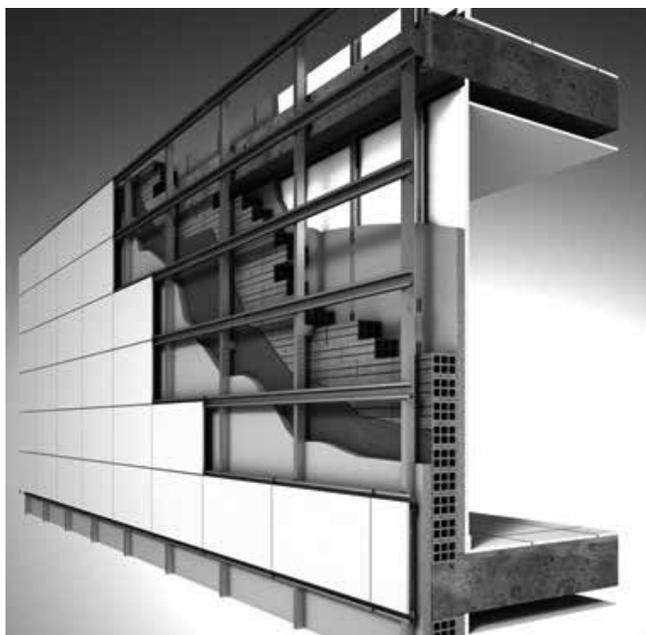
Esquema de um revestimento ventilado com painéis cerâmicos mostrando o paramento exterior e a vedação interna em alvenaria. (FAVENK, 2013)
